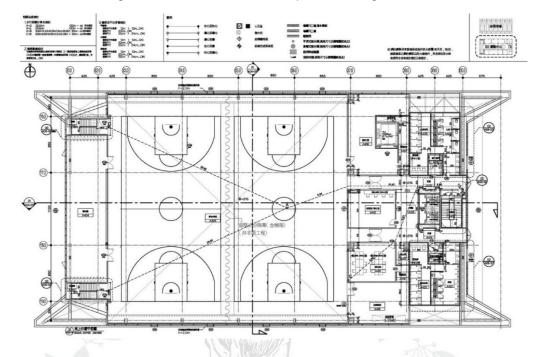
Planta Baixa Centro Esportivo Zhonghe
